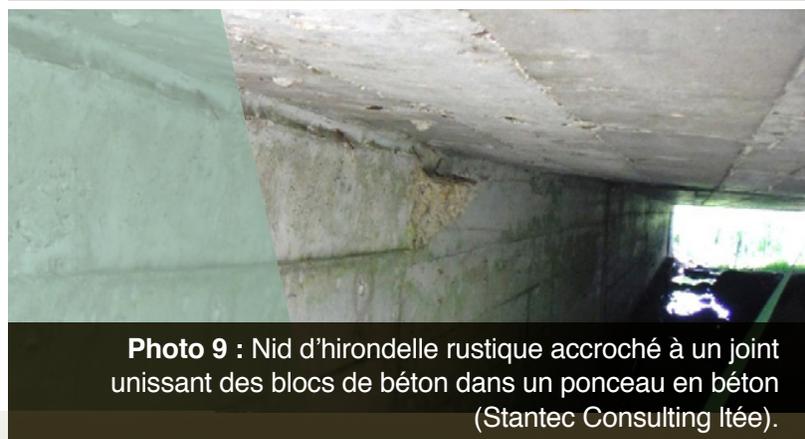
Nid d'hirondelle rustique accroché à un joint unissant des blocs de béton dans un ponceau en béton (Stantec Consulting ltée).
